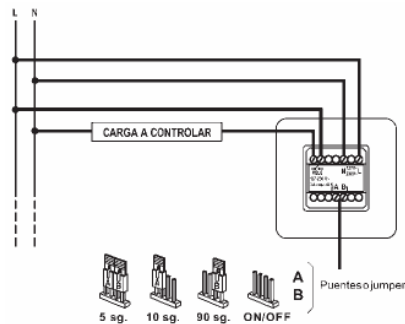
Esquema de conexiones del teclado codificado para cargas y dispositivos con entrada NO libre de potencial.
